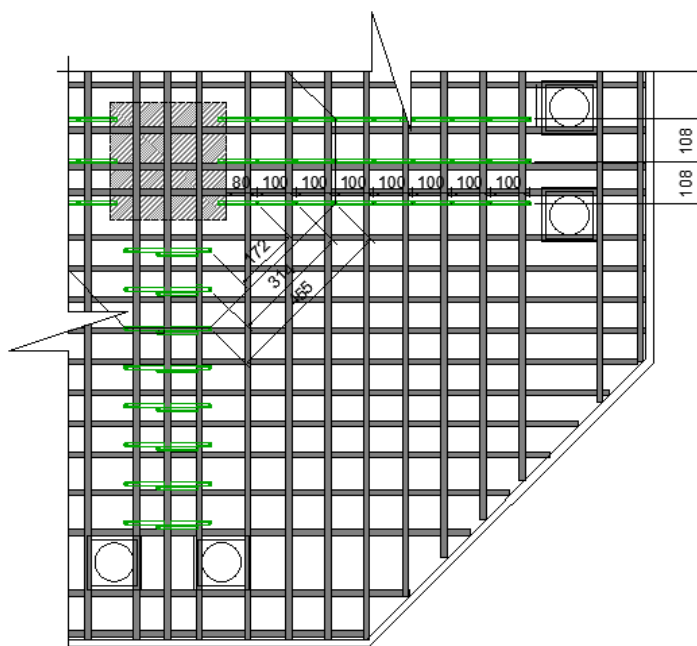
Disposição geral dos estribos em um quadrante (Autora, 2023).
